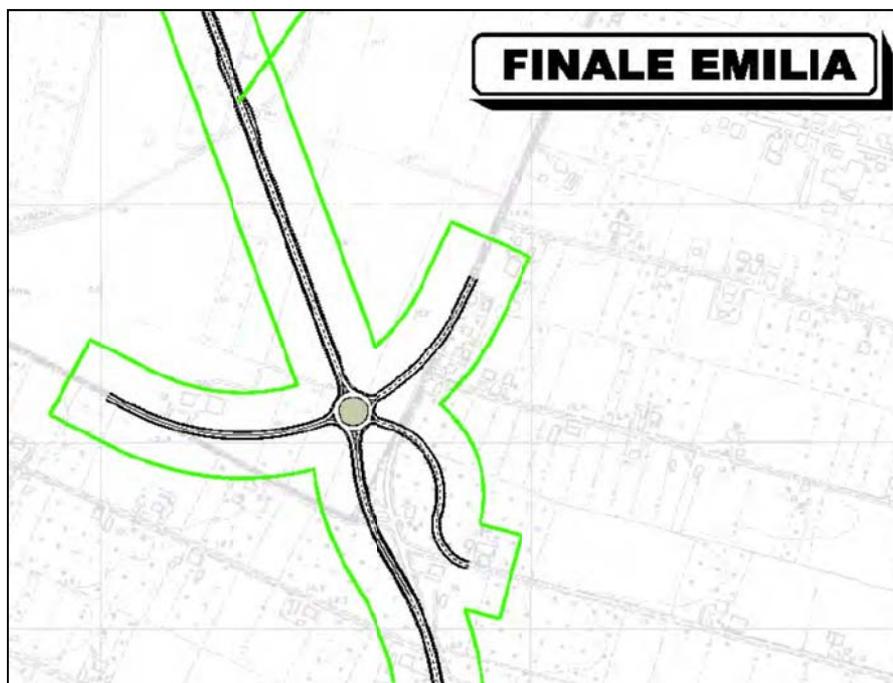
STRALCIO PLANIMETRICO PP DELLA ROTATORIA C09-R2
